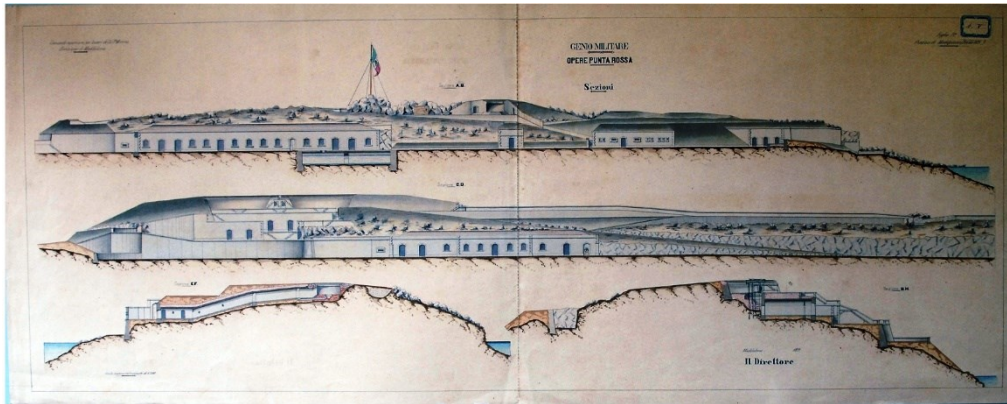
Disegni degli elevati di Punta Rossa, 1891 (arch. P. Cianchetti)
